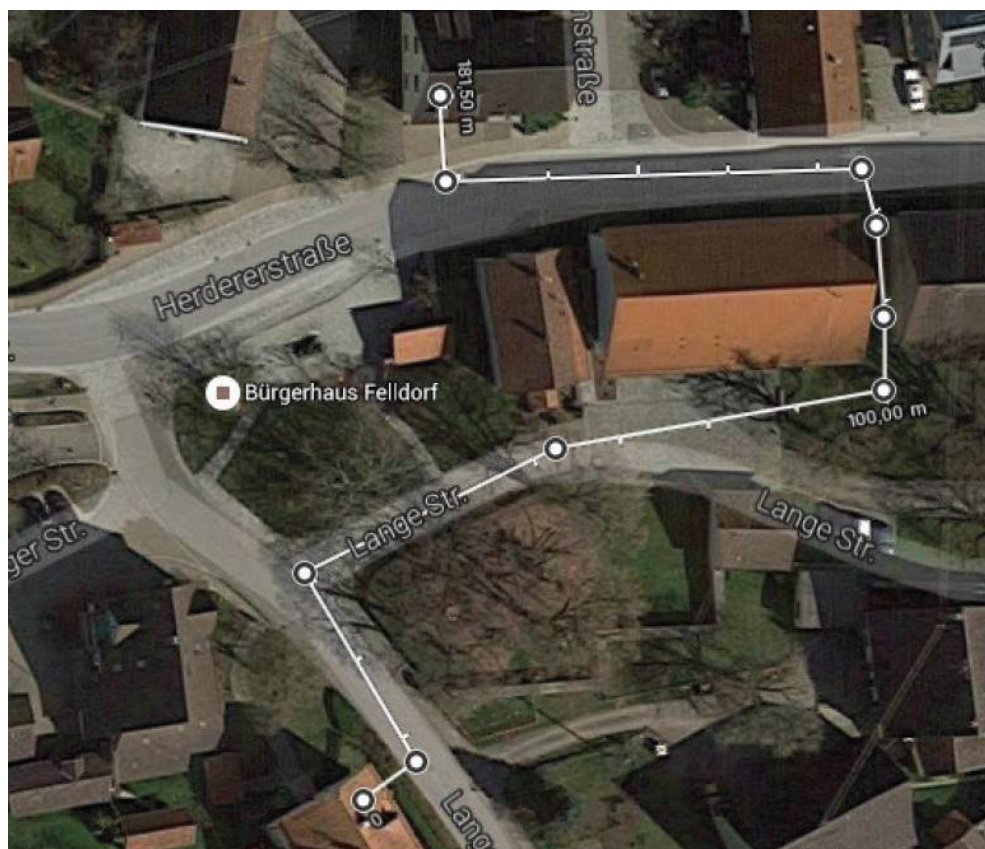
Lageplan Nahwärmenetz mit Pelletanlage
